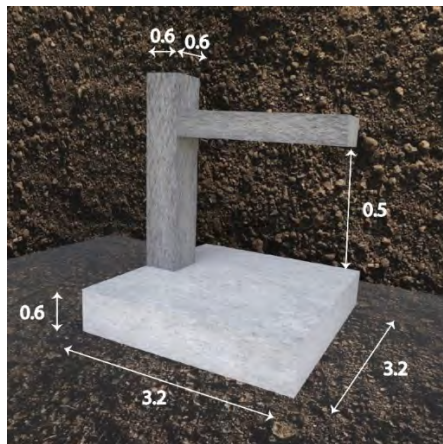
Dimensiones zapatas medianeras ejes C1 y C4
